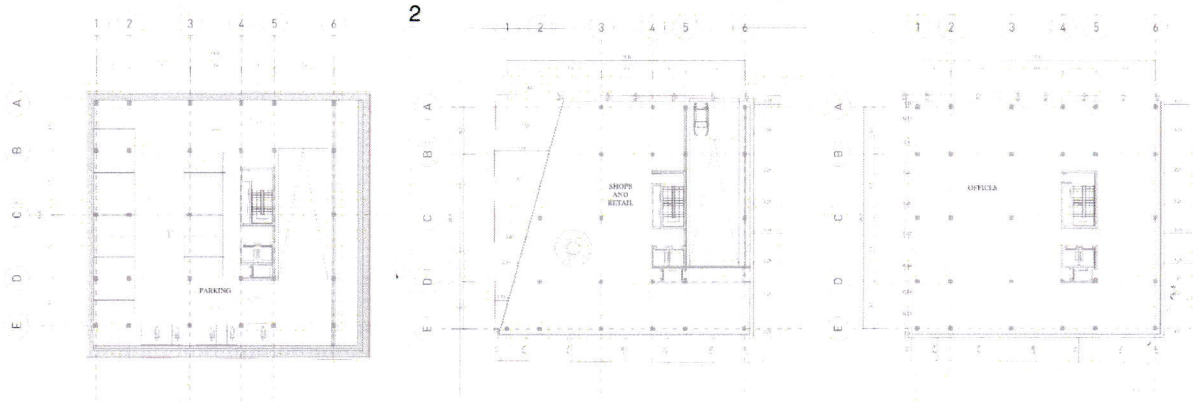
planet tip te: parkimeve, kati i biznesit dhe kai i zyrave
